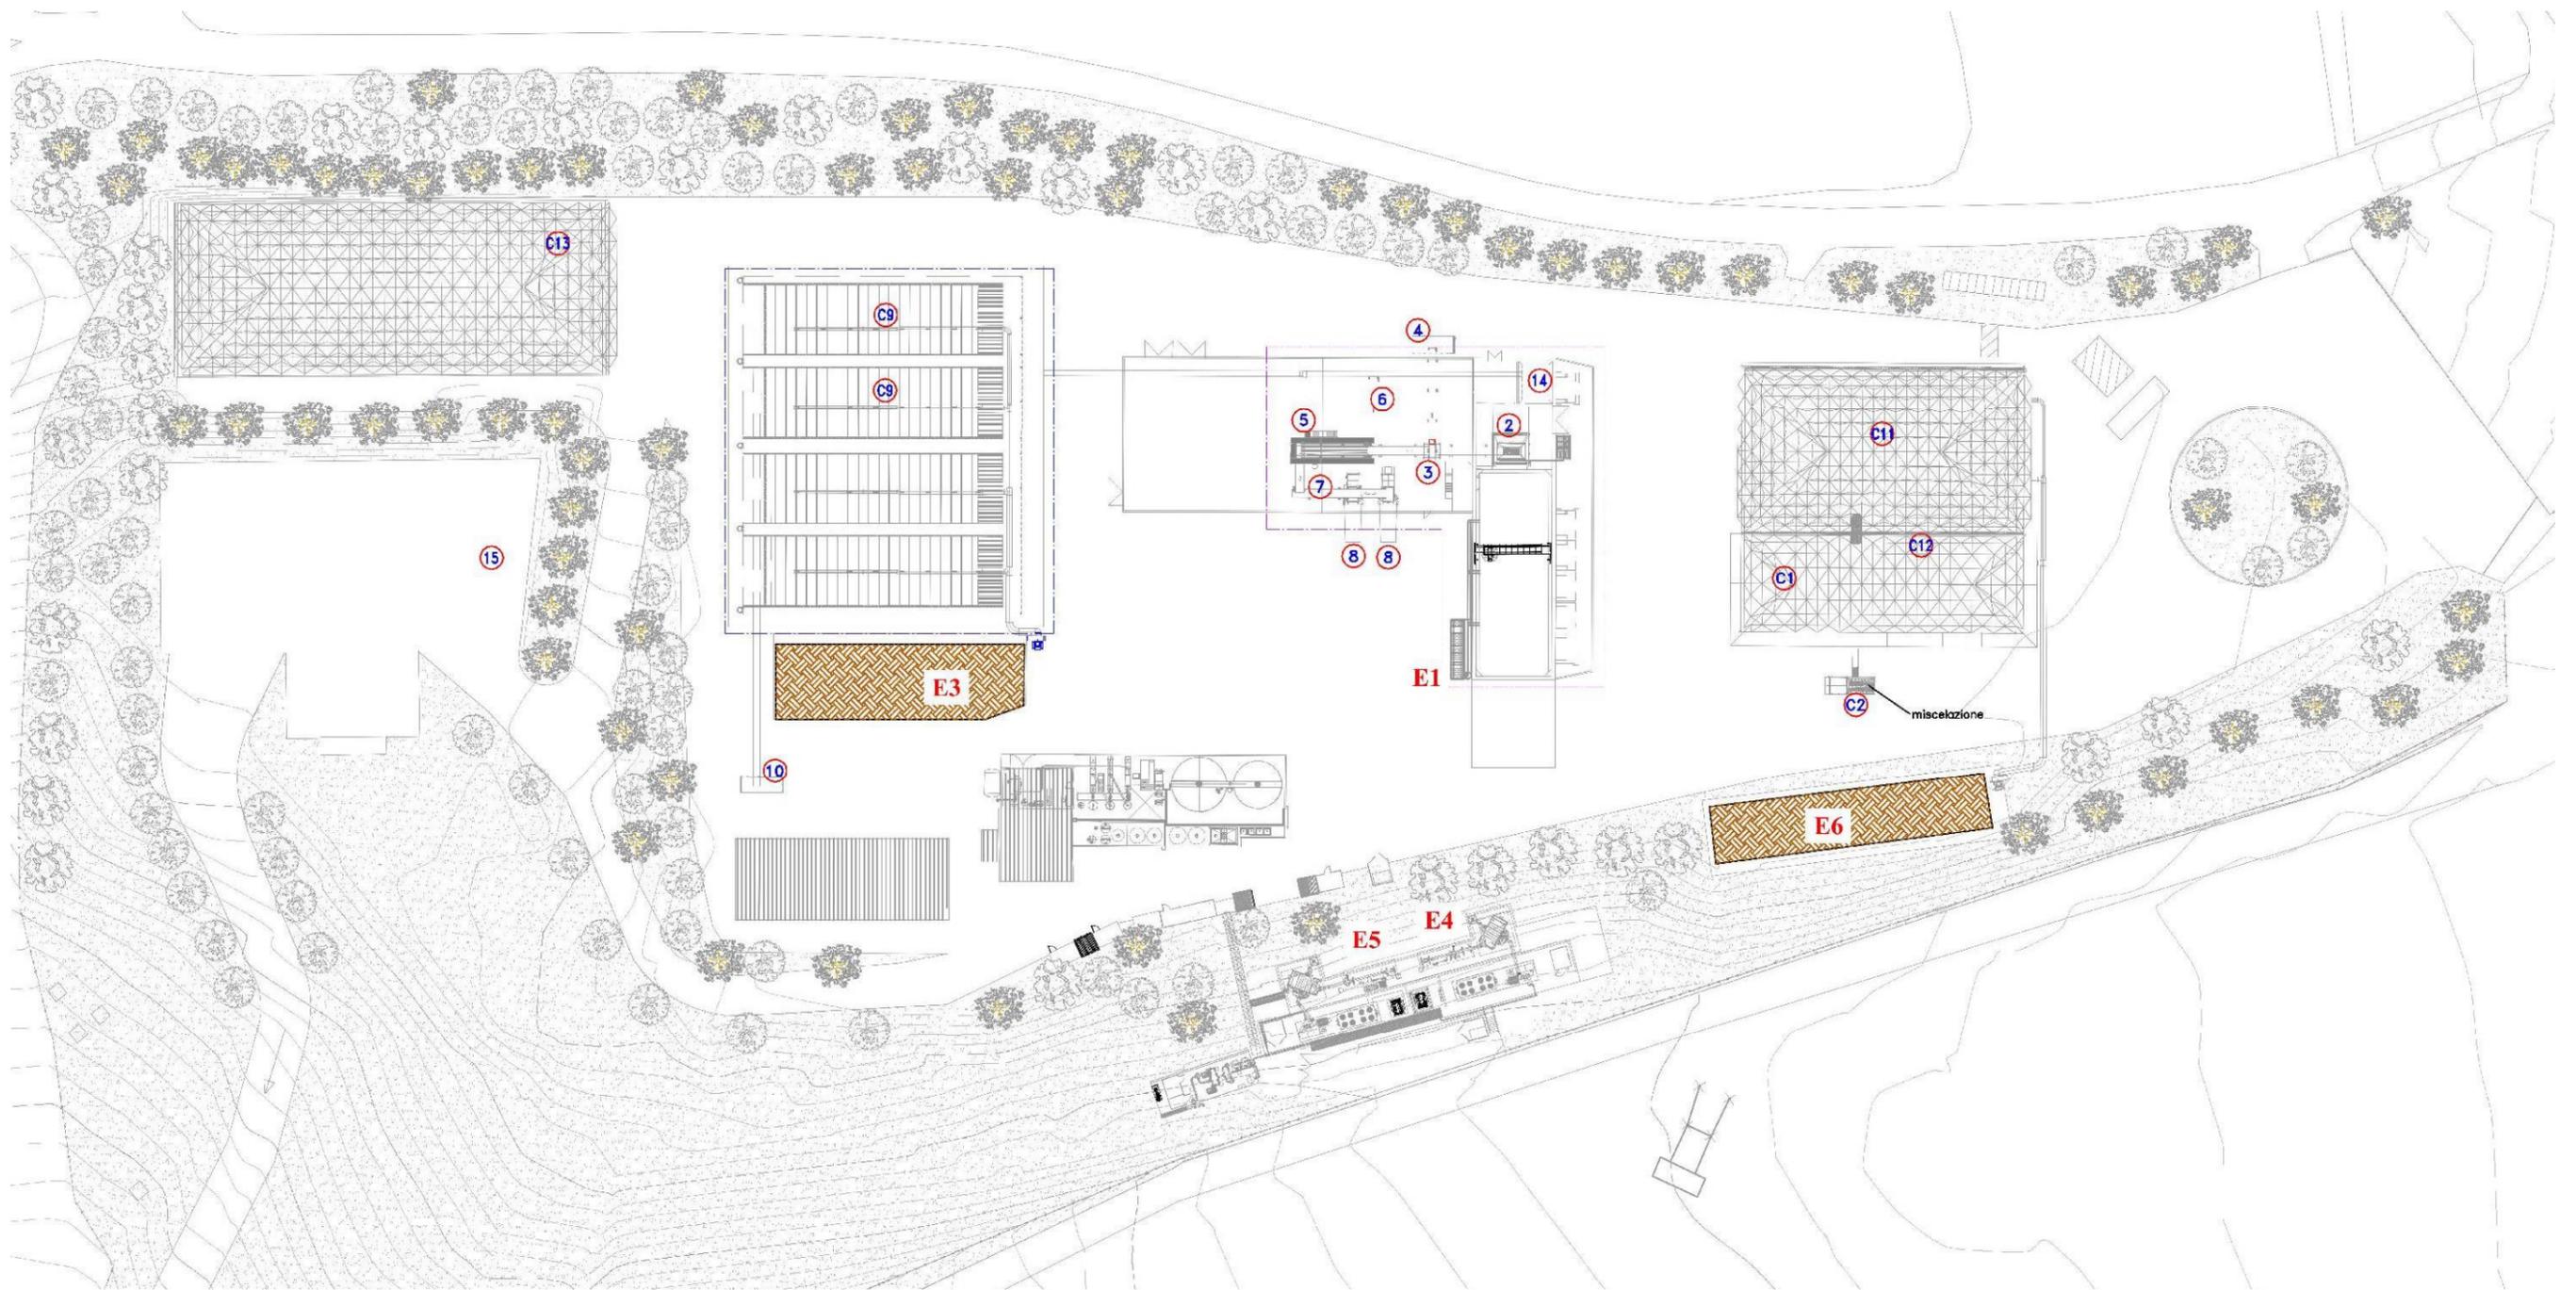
Planimetria con individuazione punti diagramma di flusso Compostaggio
